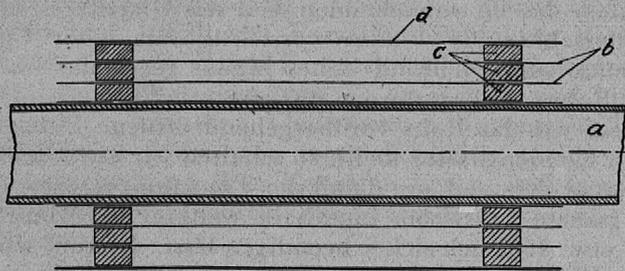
Schema einer Aluminiumfolien-Isolierung. (Planfolie)
